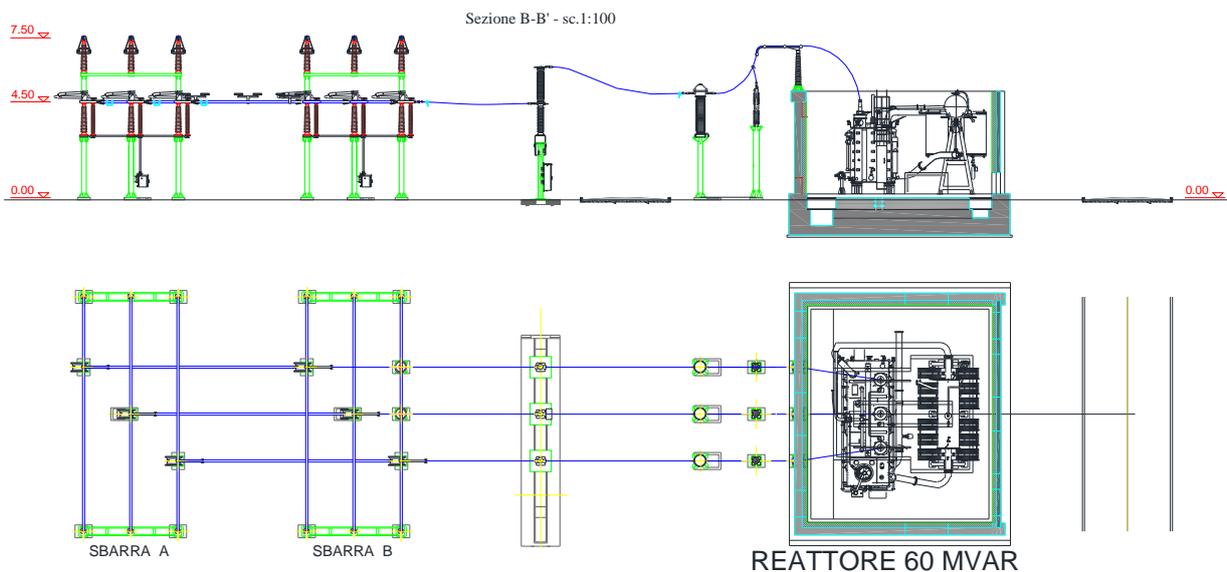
SEZIONE B-B' DELLA STAZIONE
